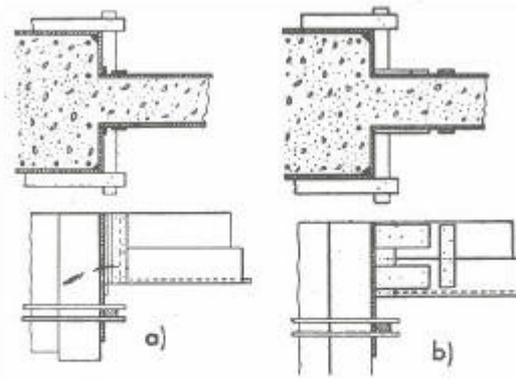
Emendas da fôrma de viga com a fôrma do pilar.
